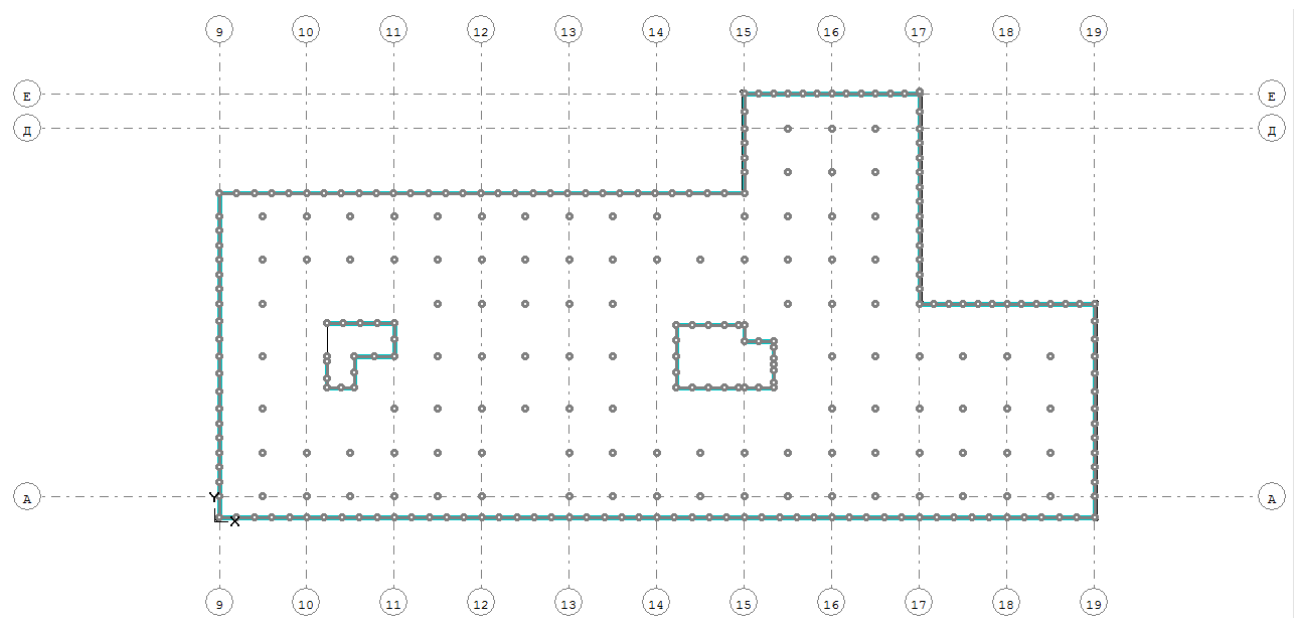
Опалубкове креслення плити перекриття на відмітці 0,000
